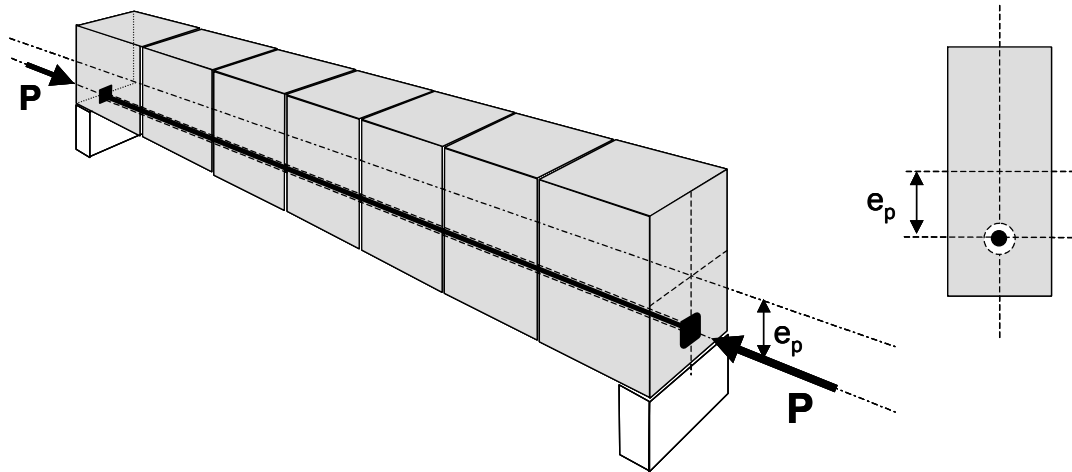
Uma viga de elementos pré-moldados de concreto
